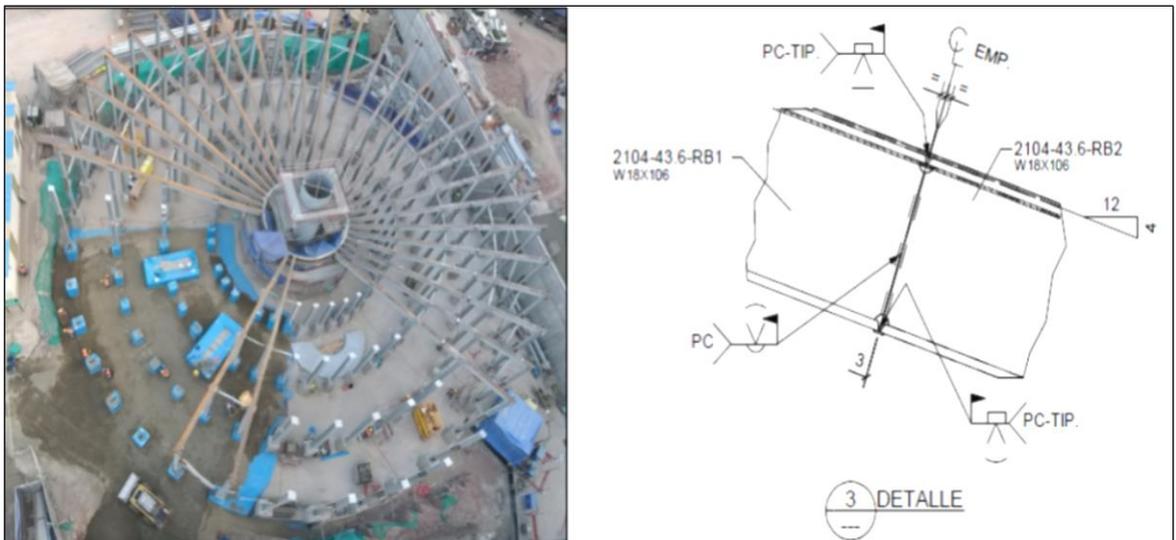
Montaje de vigas radiales y detalle de unión soldada
